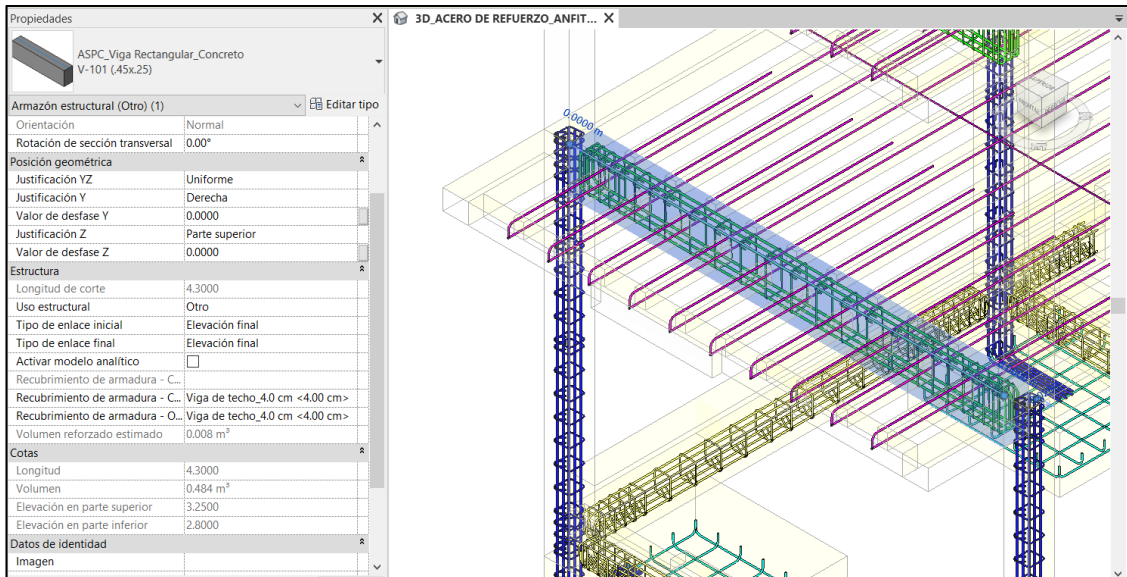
Vista 3D – Acero de Refuerzo en Vigas de Techo en BIM
